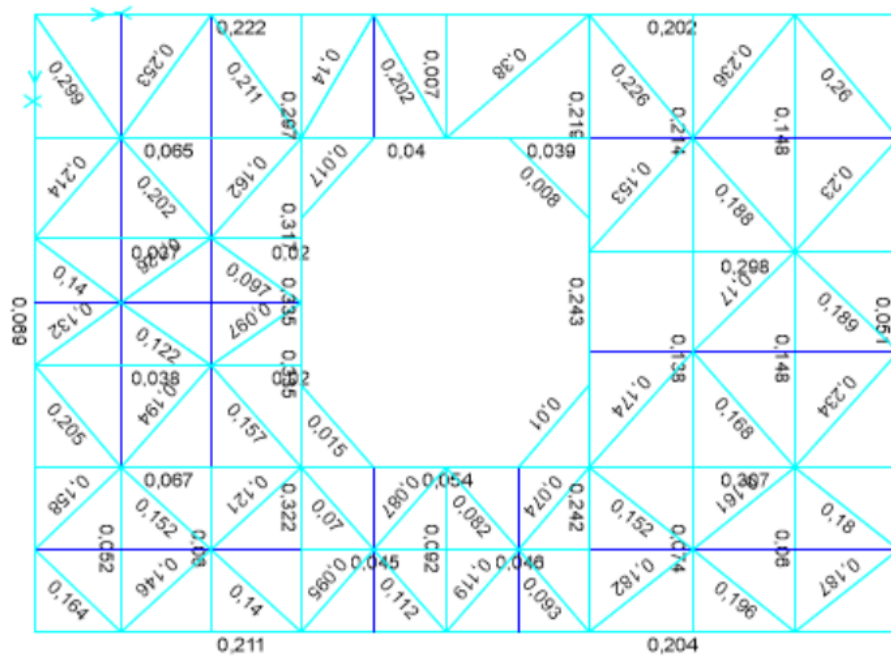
Factores de utilización vista en elevación 12.04 [m] sobre nivel de terreno.
